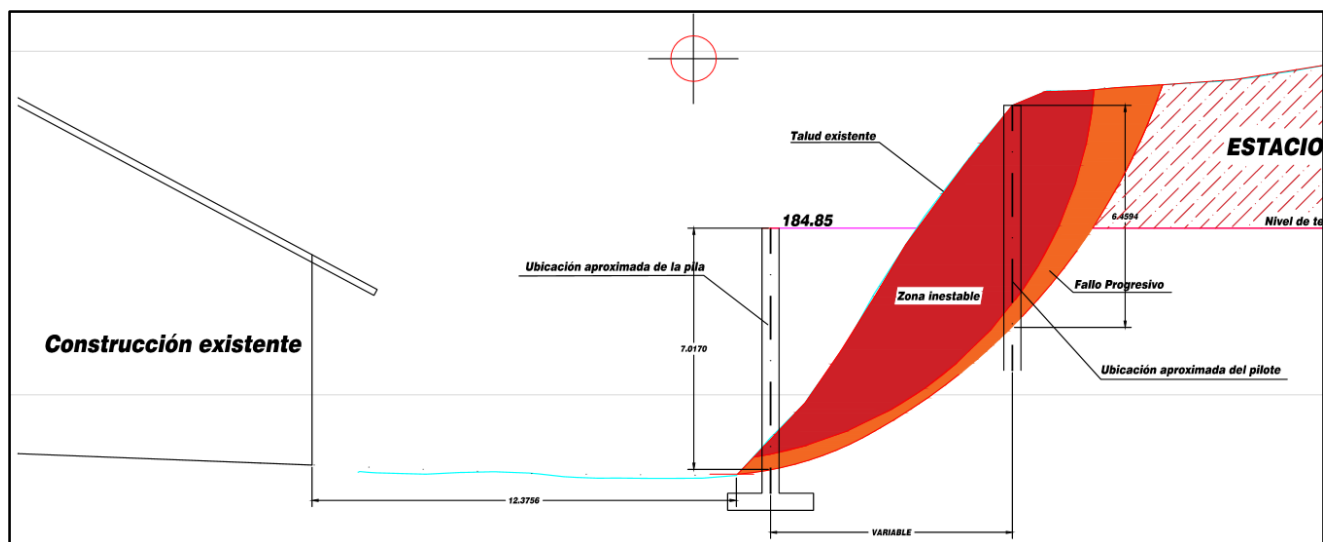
Ilustración sobre ubicación de pilas y pilotes en el perfil 5.
